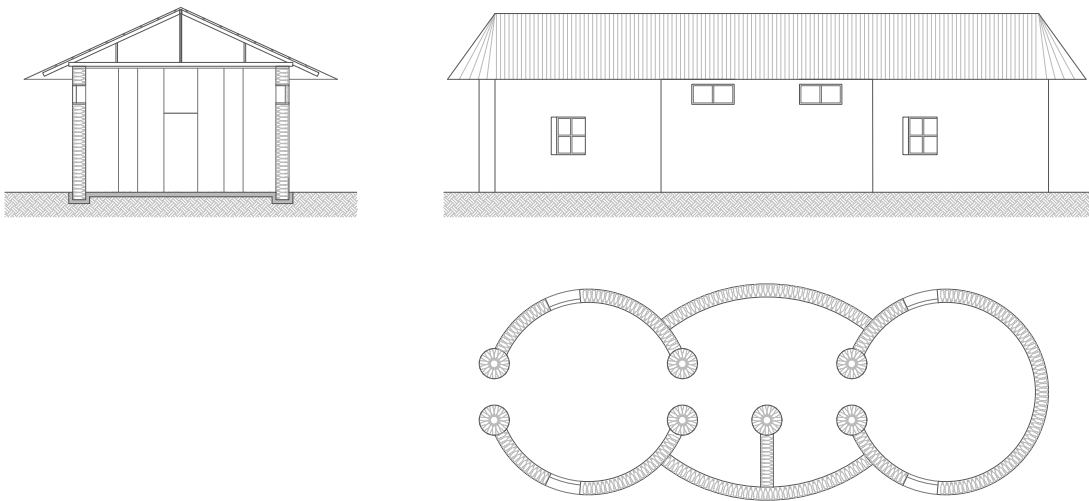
Planta, alzado y sección de la vivienda de Yelwa.
